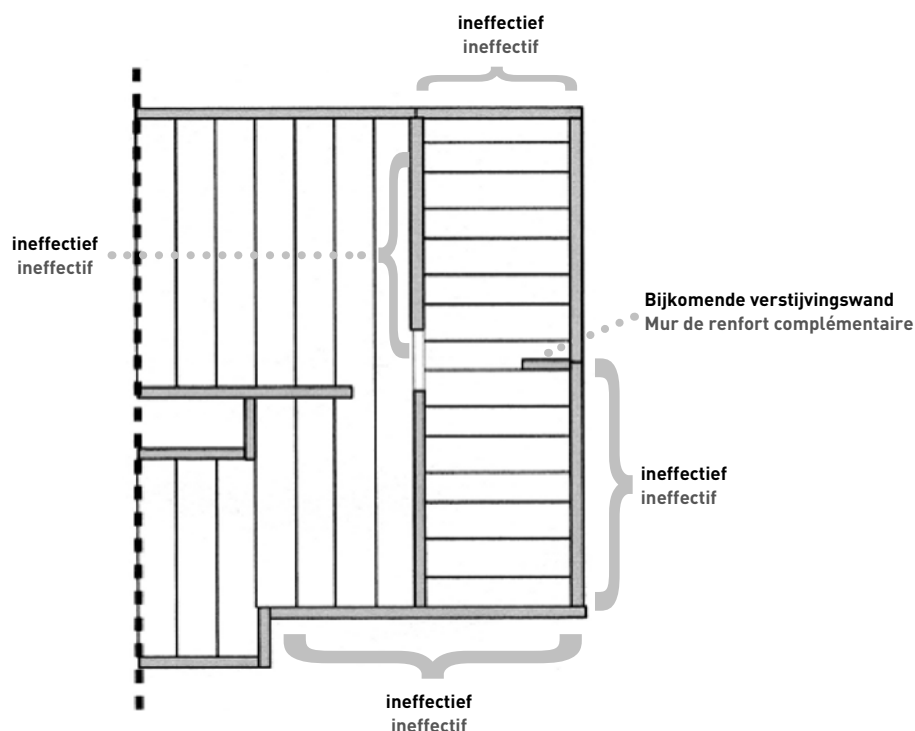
Grootte van de aangenomen primaire schade bij wandconstructies
